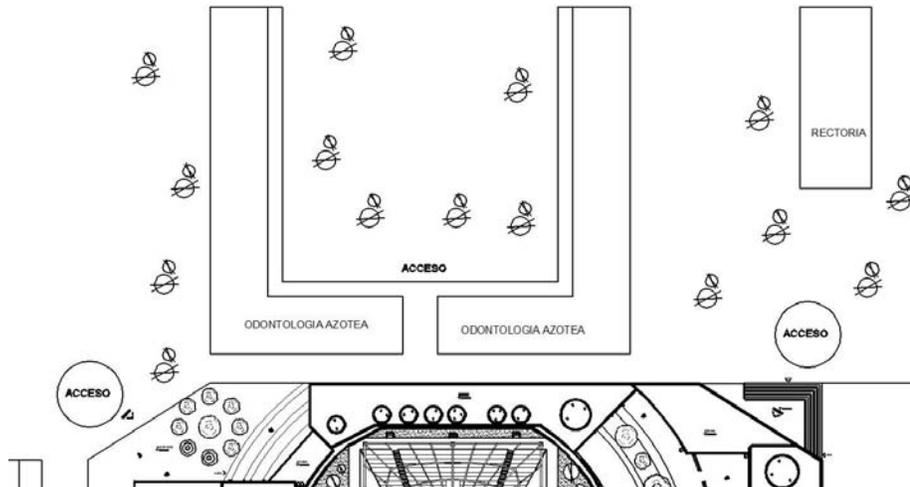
, vista en planta lado sureste, apreciándose la Facultad de odontología y la fachada trasera del proyecto.
